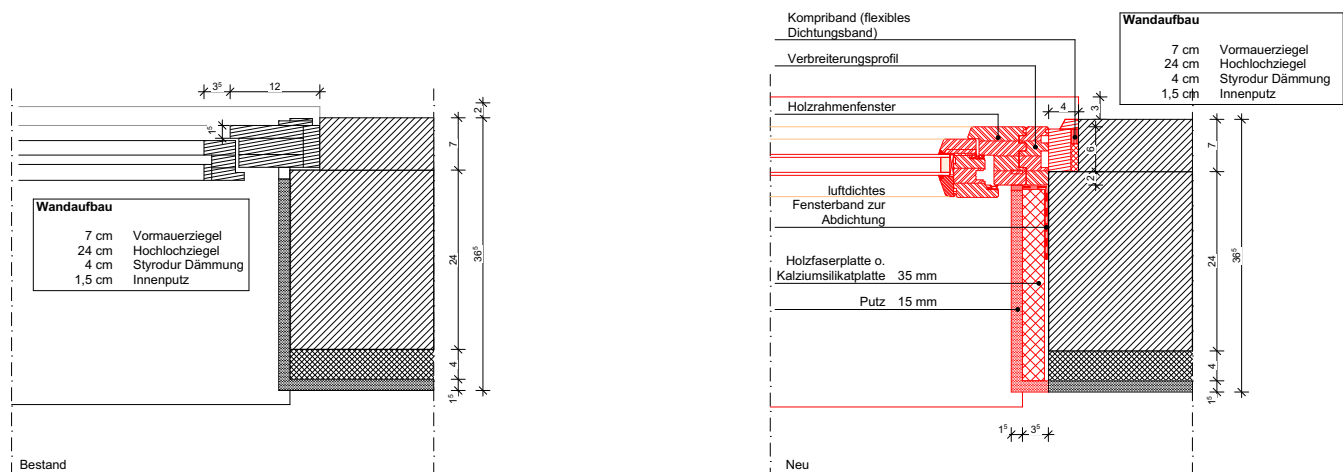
Horizontalschnitt Konstruktionsvorschlag Neueinbau Fenster
